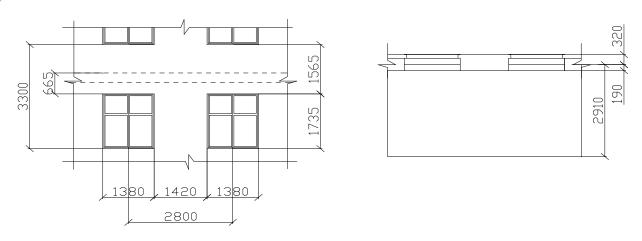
Размеры рассчитываемого простенка и грузовая площадь
